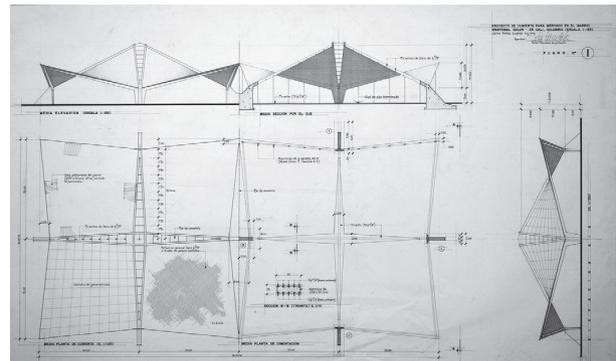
Detalle de las cubiertas para bodegas el mercado Cristóbal Colón, 1960.
